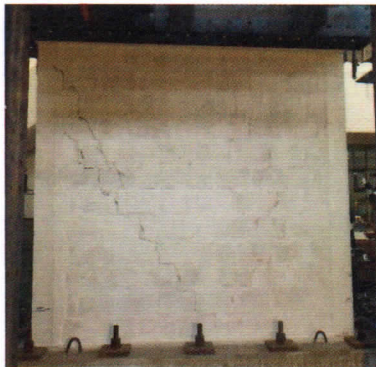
Primeras grietas diagonales en la parte extrema del muro para una distorsión 1/2150 Vista cara Sur.
